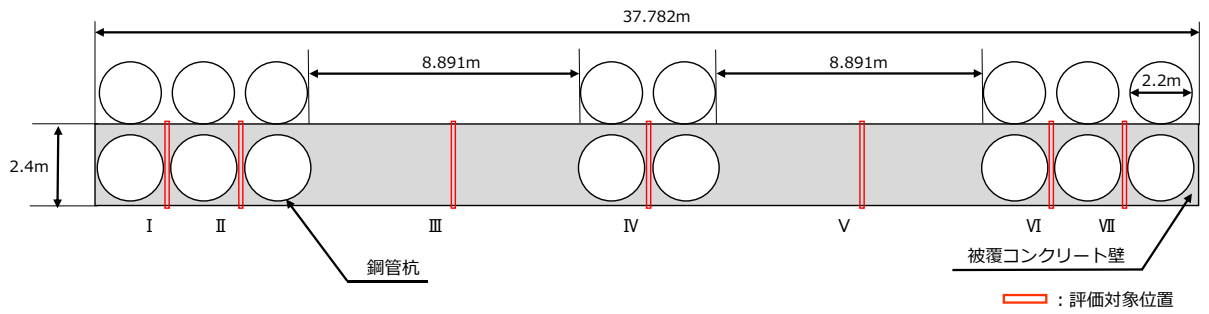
(1) 評価対象位置図 (④-④断面, 平面図)
